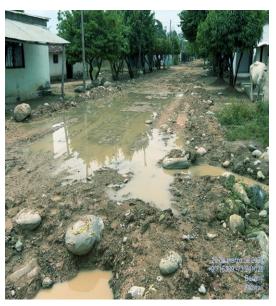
y 11. Muestran el estado en las que se encuentran unas calles del sector intervenido.
